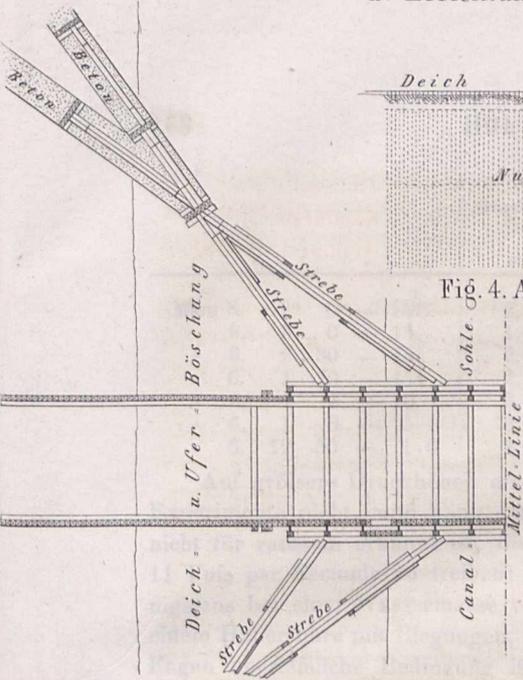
Grundriss der Verstreibungen und des Rammwerkes.
